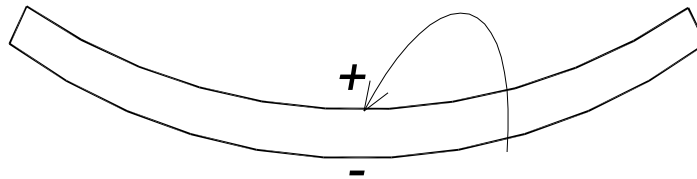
Losa de Cimentación en la condición Edge Lift.
